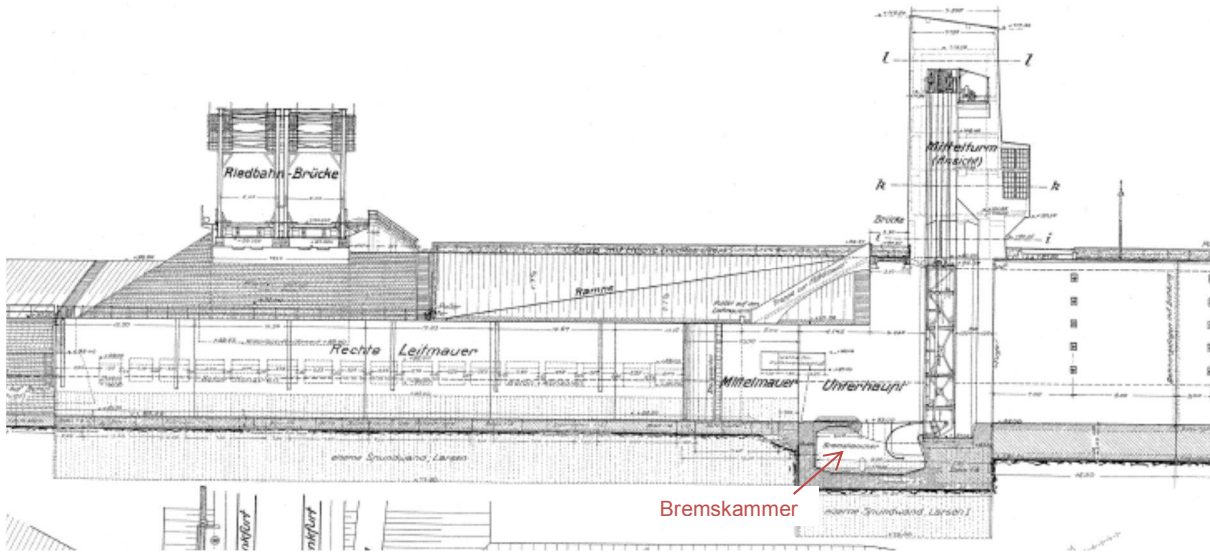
Längsschnitt des bestehenden Unterhauts der linken Kammer
